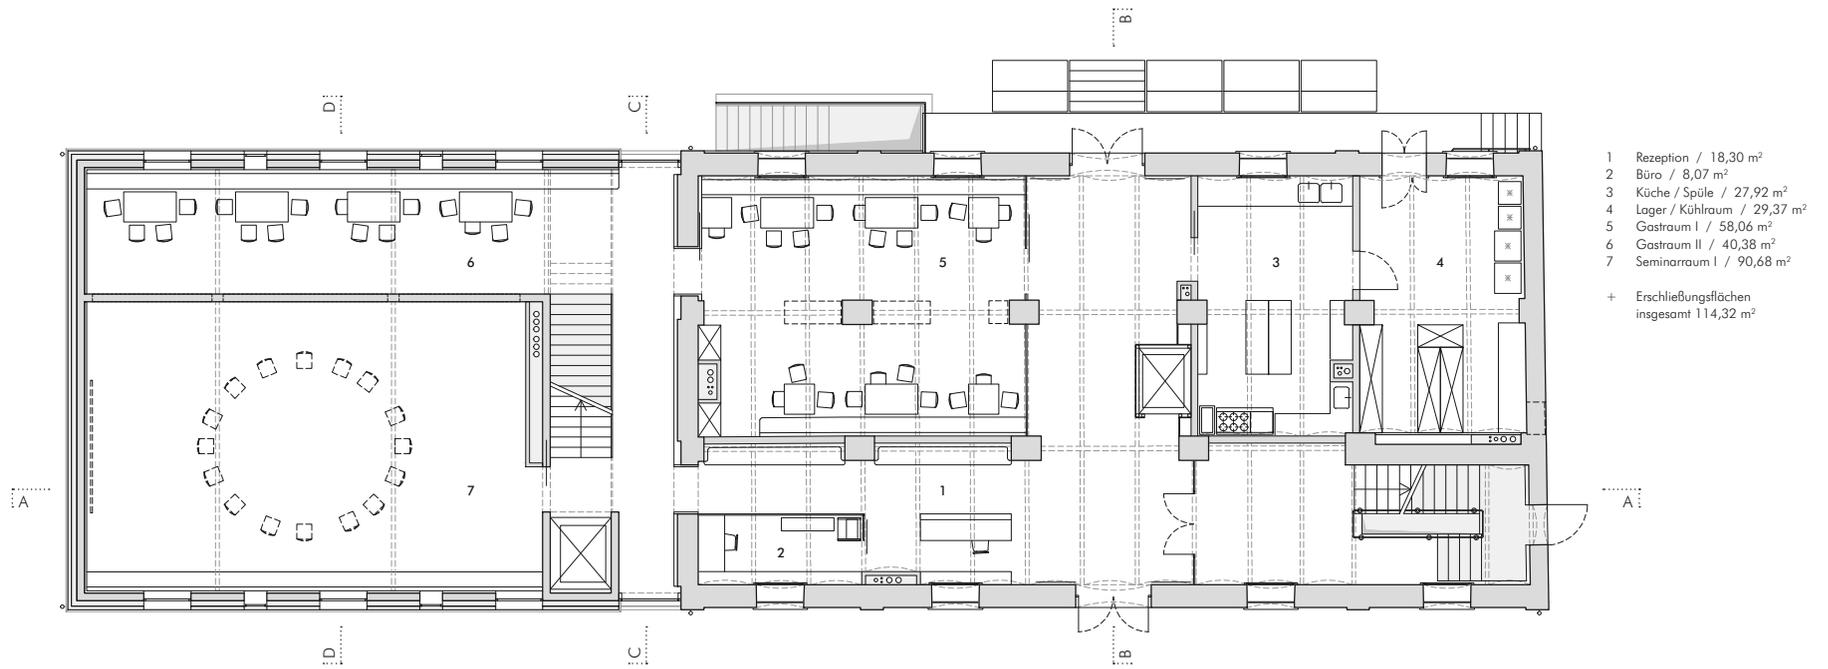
Grundriss Erdgeschoß, Entwurf, M 1:200
